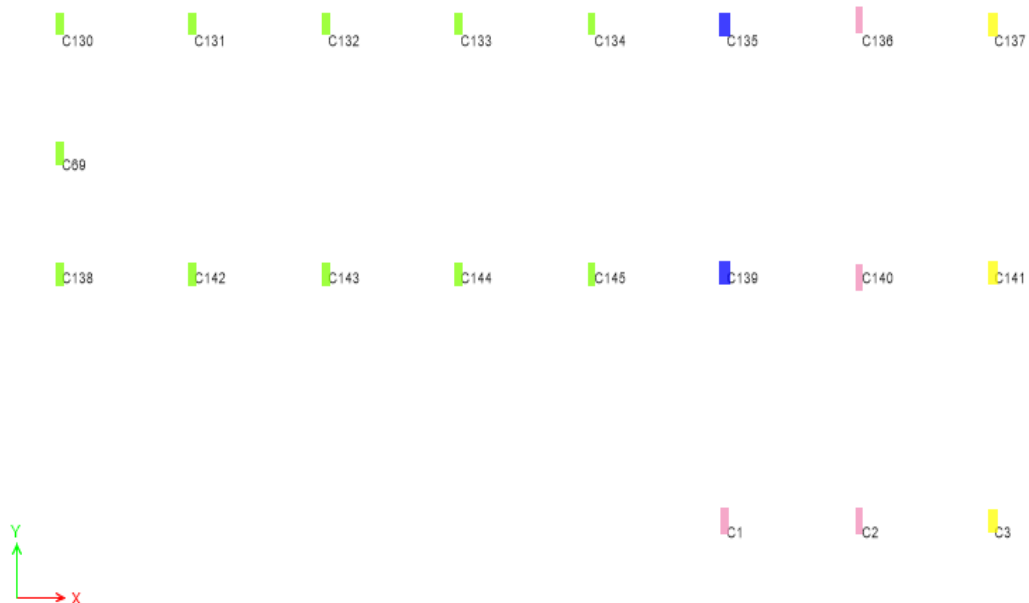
Identificación de columnas en planta de restaurante en el modelo ETABS
